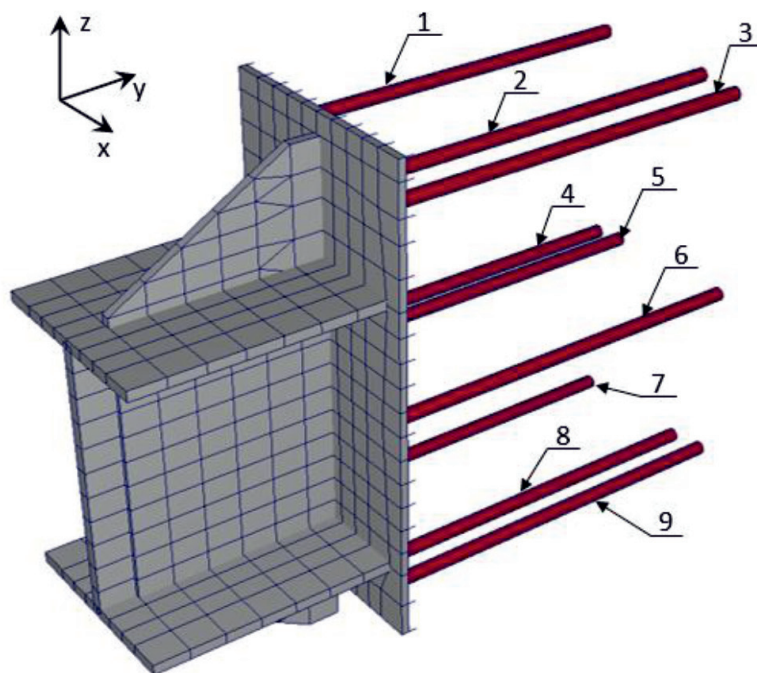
Расчетная схема узла крепления консоли с фактическим положением арматурных стержней 1...9
